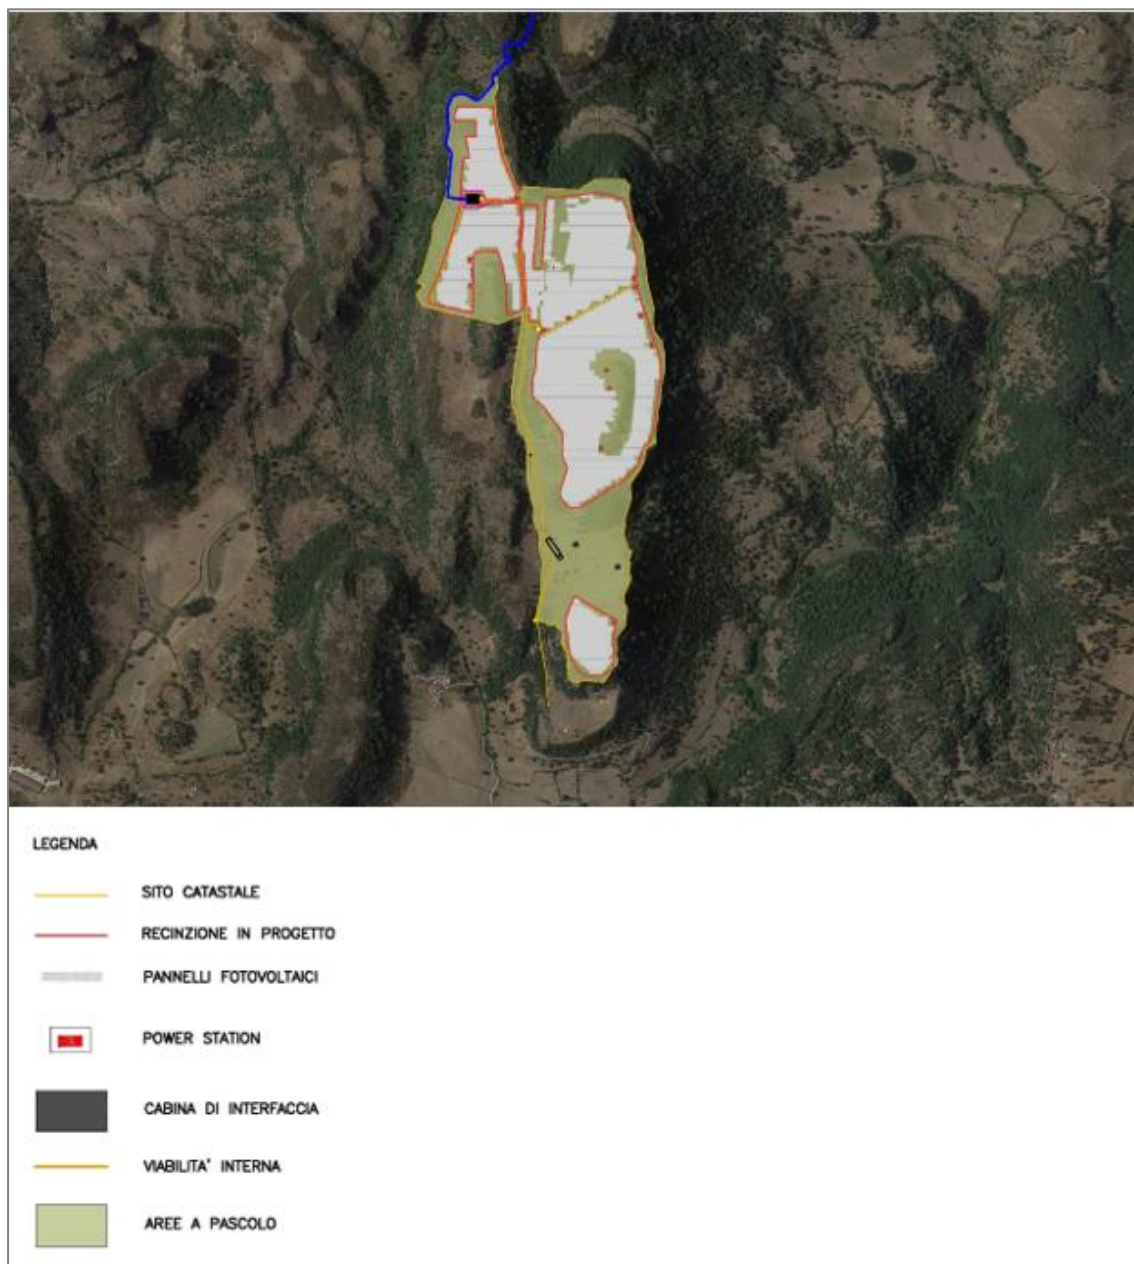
Planimetria delle opere di valorizzazione colturale
